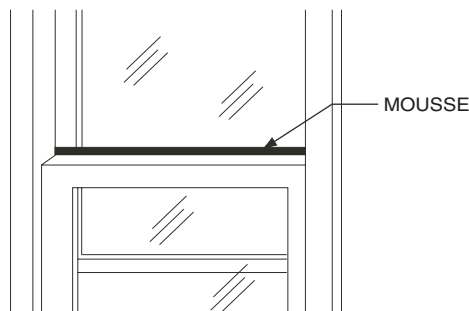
EMPLACEMENT DE LA MOUSSE DU CHÂSSIS
